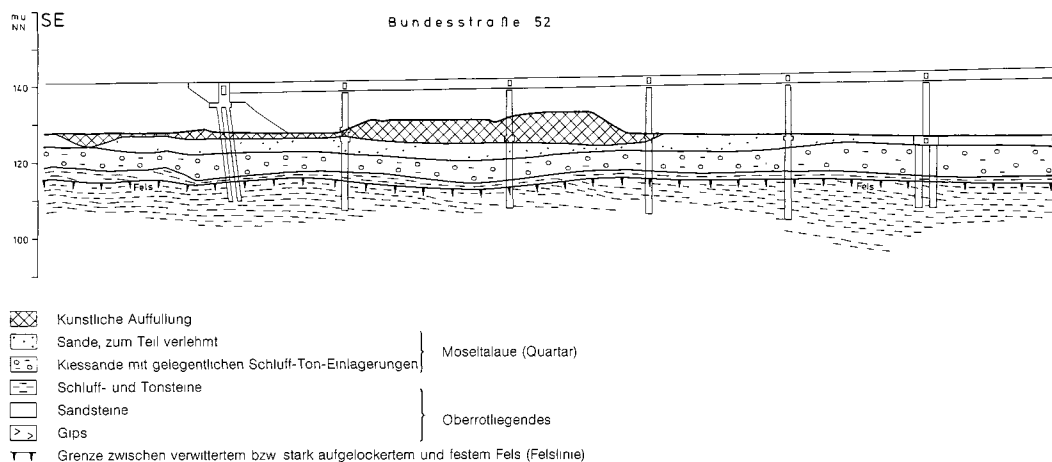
Brücke über den Bahnhof Ehrang (Profil 1).
